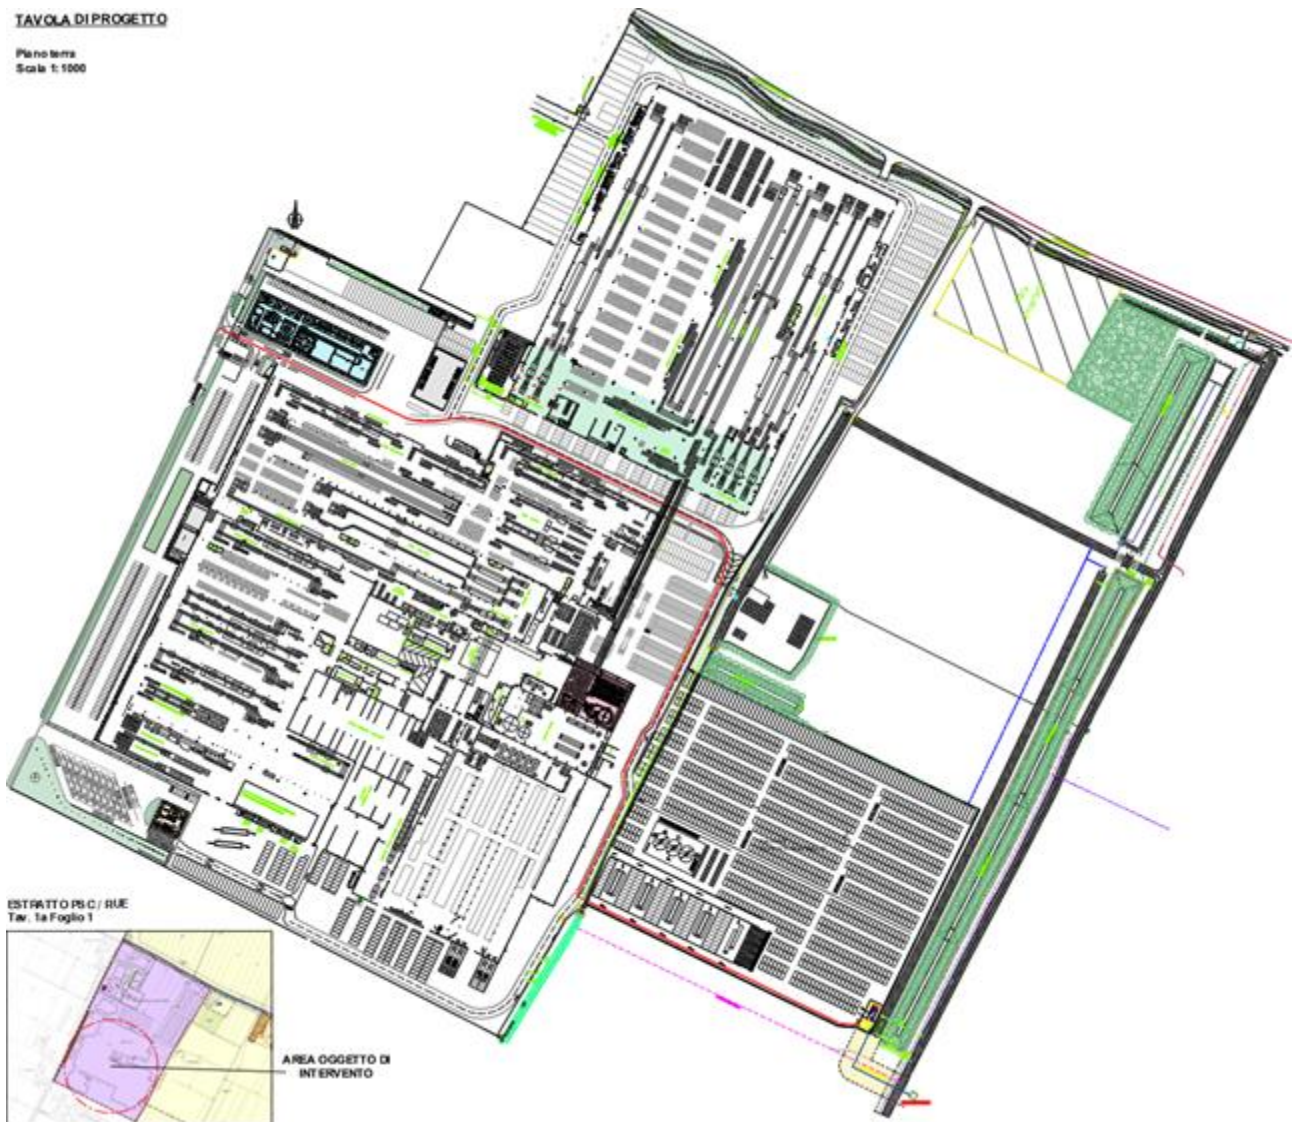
c - Pianta dello stabilimento – STATO di PROGETTO
